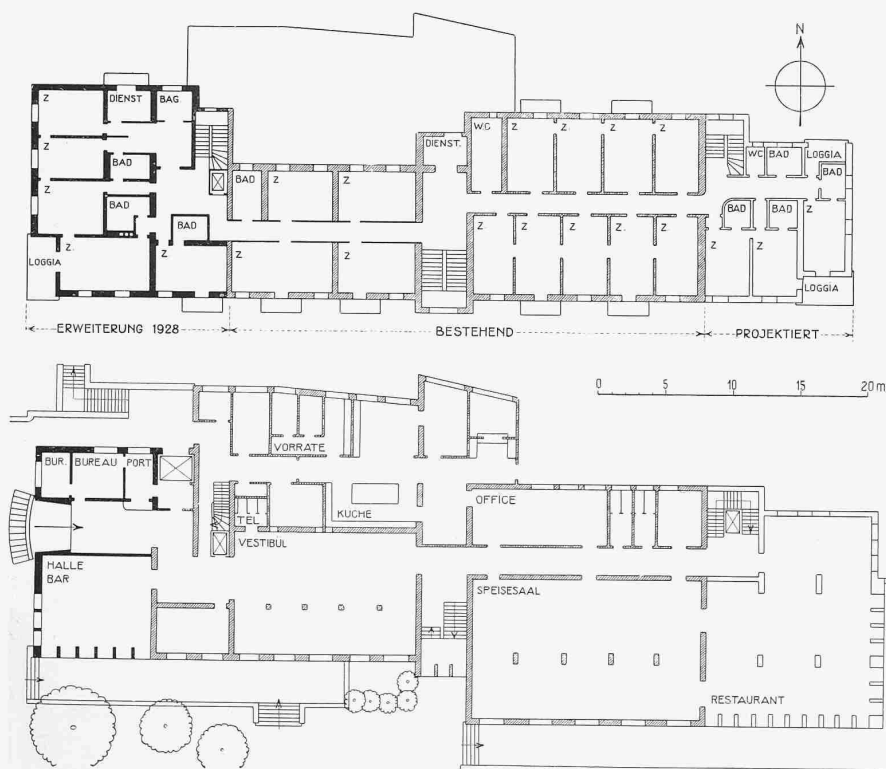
u. 6. Grundrisse 1 : 500.
